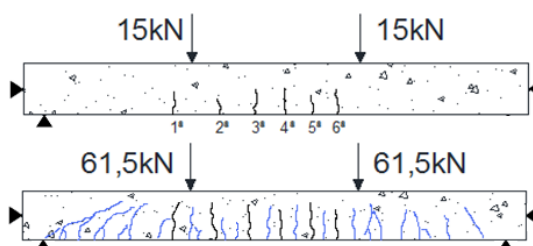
Formação e evolução das fissuras da Viga6.
